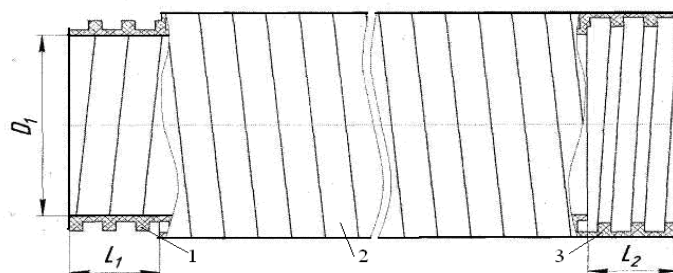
Труба под соединение с помощью экструзионной сварки (труба POLYCORR SVT ЭС) либо ленты с закладными спиральями
